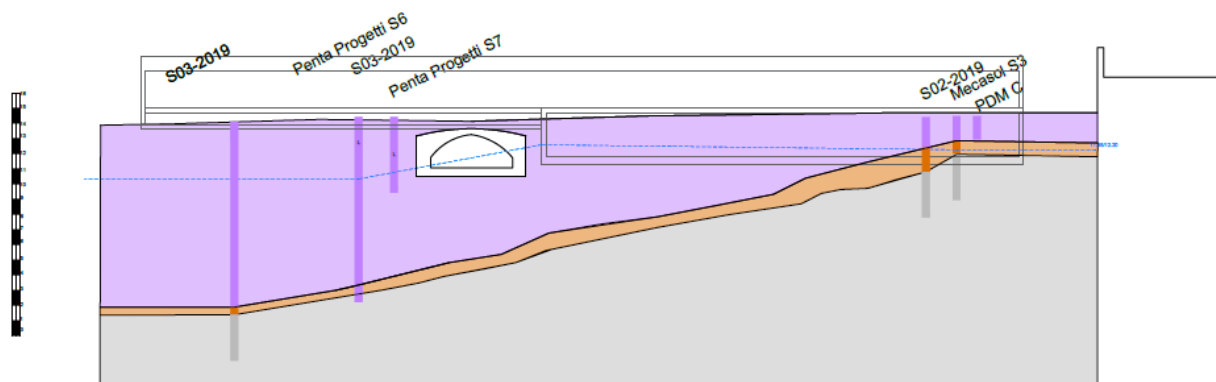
Sezione indicativa della galleria idraulica e interrato di progetto.
